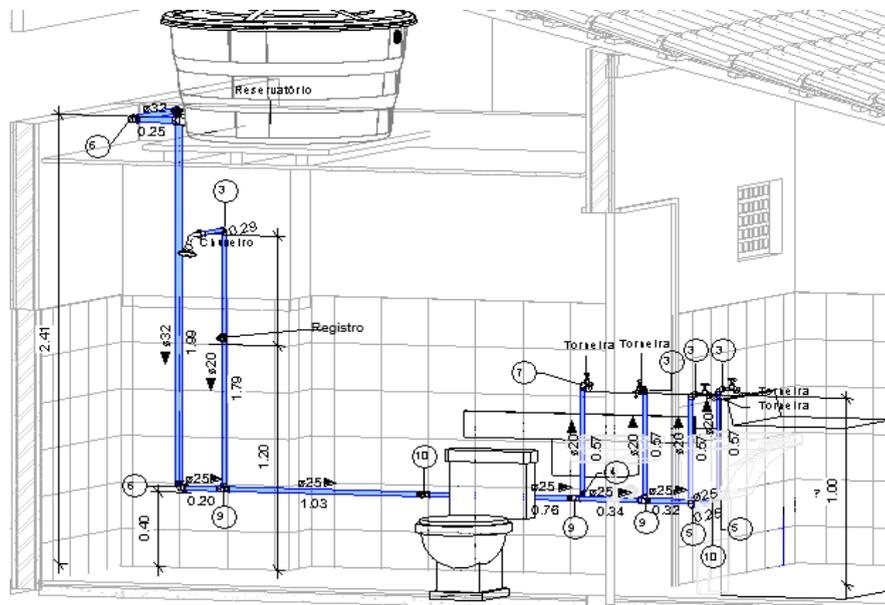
Planta baixa geral modificada de instalação hidráulica
